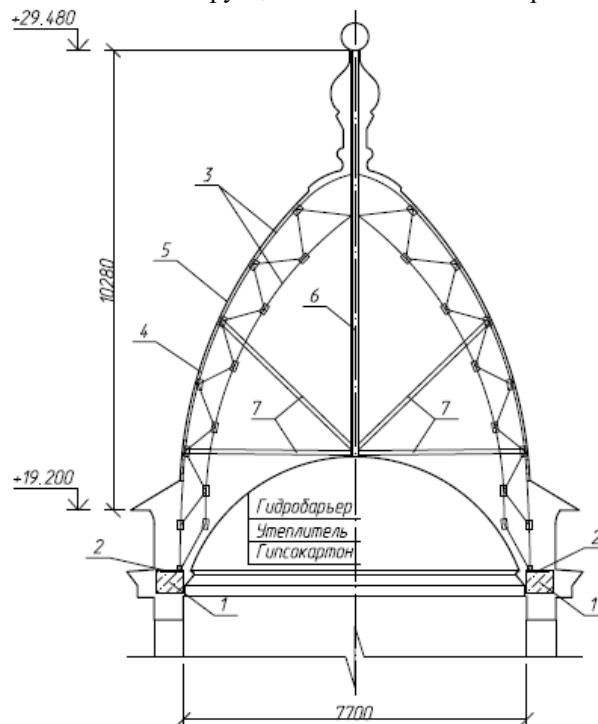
Конструктивная схема купольной конструкции: 1 – монолитный пояс; 2 – закладная деталь металлической пяты; 3 – пояса фермы; 4 – сплошная обрешётка; 5 – листы оцинкованной стали; 6 – центральная мачта Креста; 7 – подкосы.
